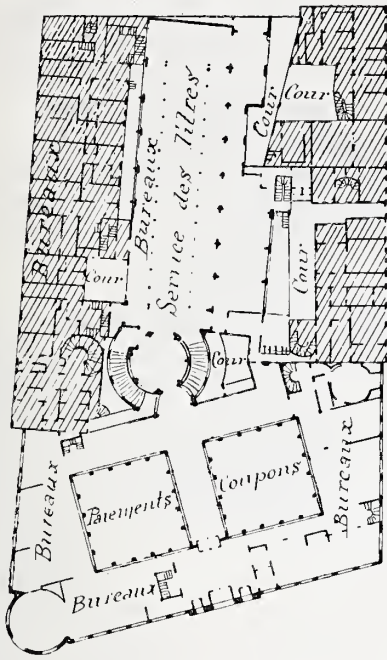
Plan du nouveau Crédit Lyonnais.
